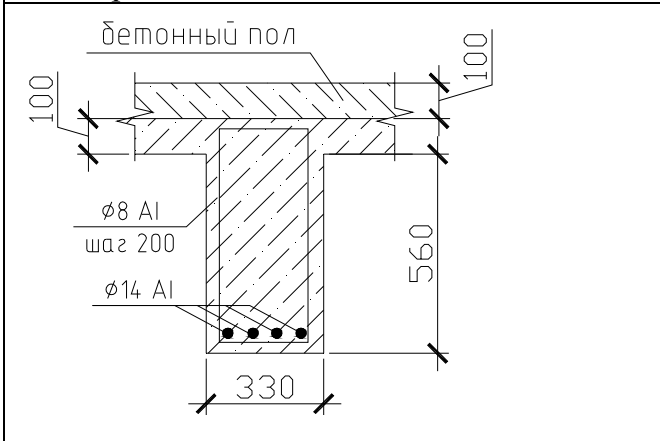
Главная балка ж/б перекрытия фойе над первым этажом в осях «1-7/А-Д»
